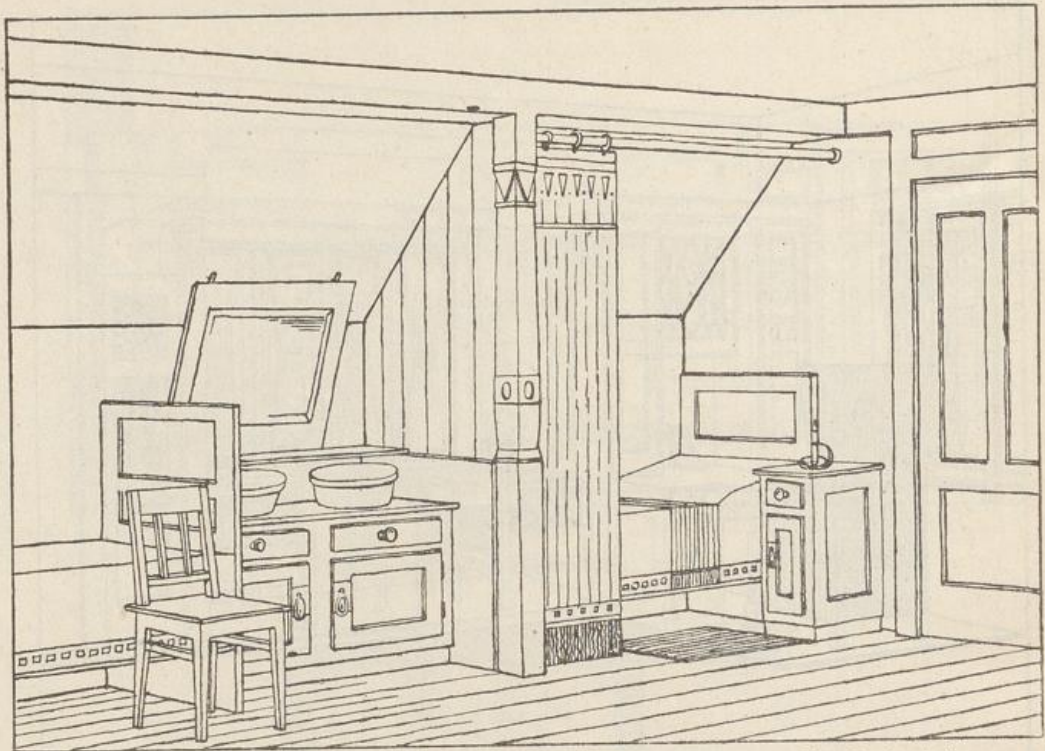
Schlafzimmer im Dachgeschoß. Betten stehen unter der Dachschräge. Stuhlsäule muß auf Bettlänge Rücksicht nehmen.
